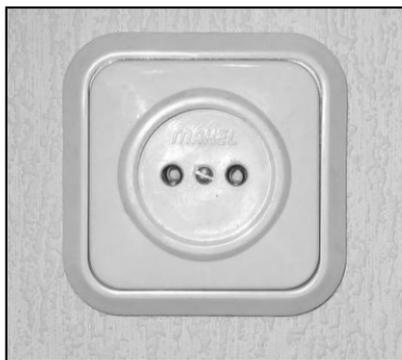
Розетка для скрытой проводки, установленная в стене
